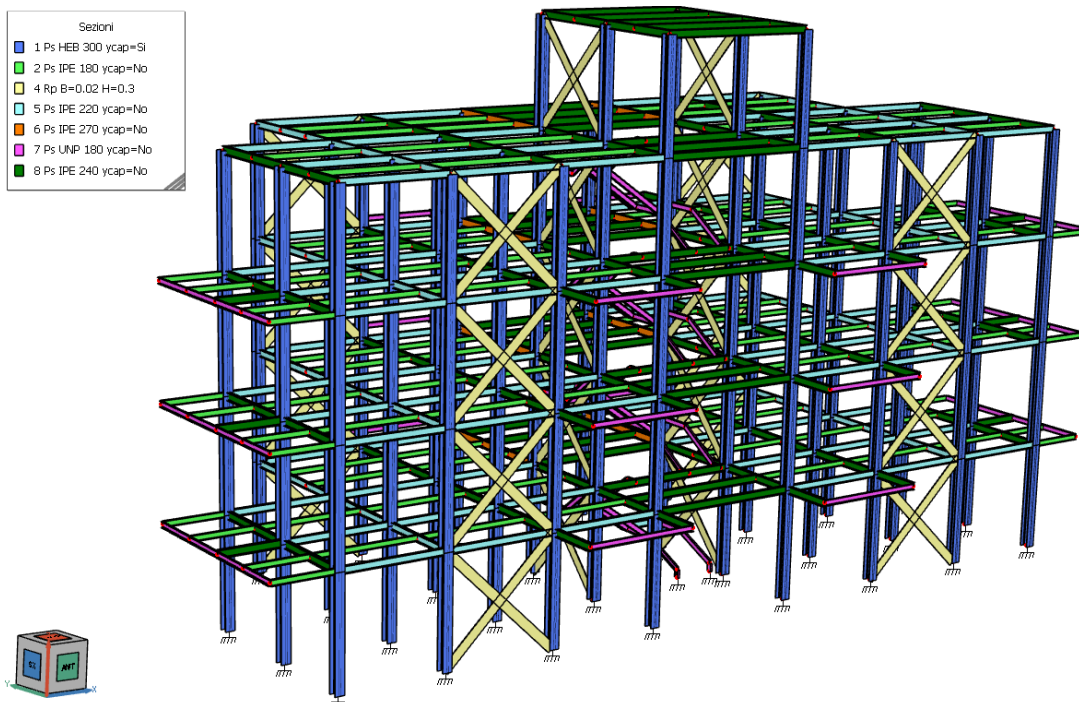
Modello FEM, con rappresentazione delle sezioni assegnate agli elementi strutturali.
